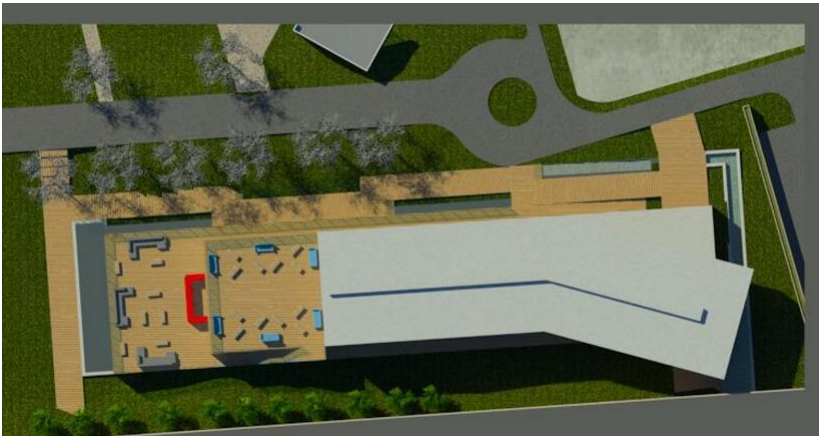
Propuesta de un Plan Maestro Vista Aérea en 3D
